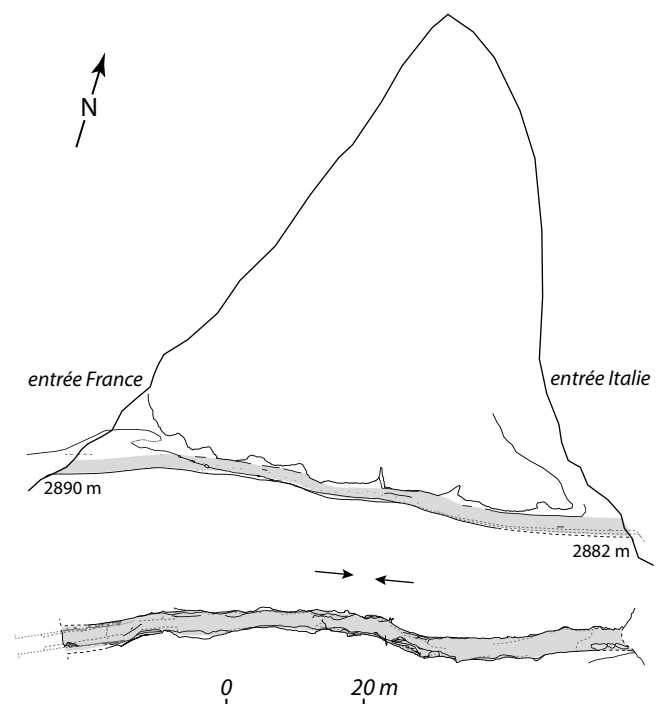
RISTOLAS, tunnel de la Traversette. Plan et profil du tunnel avec en gris le creusement de 1480 (DAO Br. Ancel).
